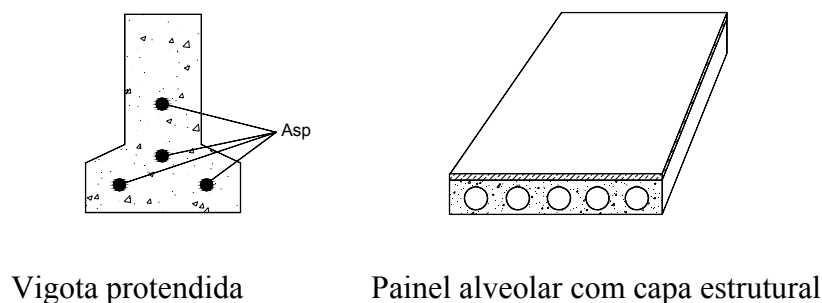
Seções transversais da vigota protendida e do painel alveolar com capa estrutural [Castilho (2003)].
